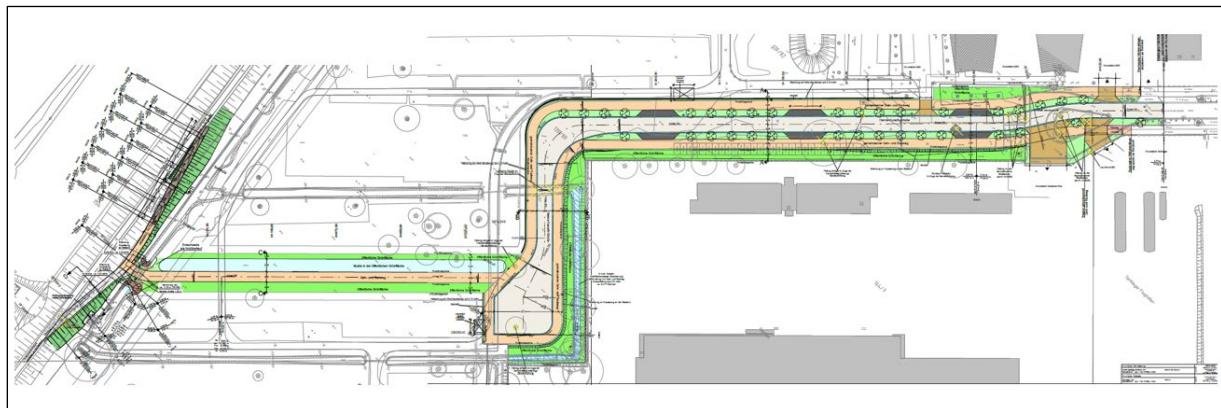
Darstellung der geplanten Verkehrsflächen und Straßenführung
